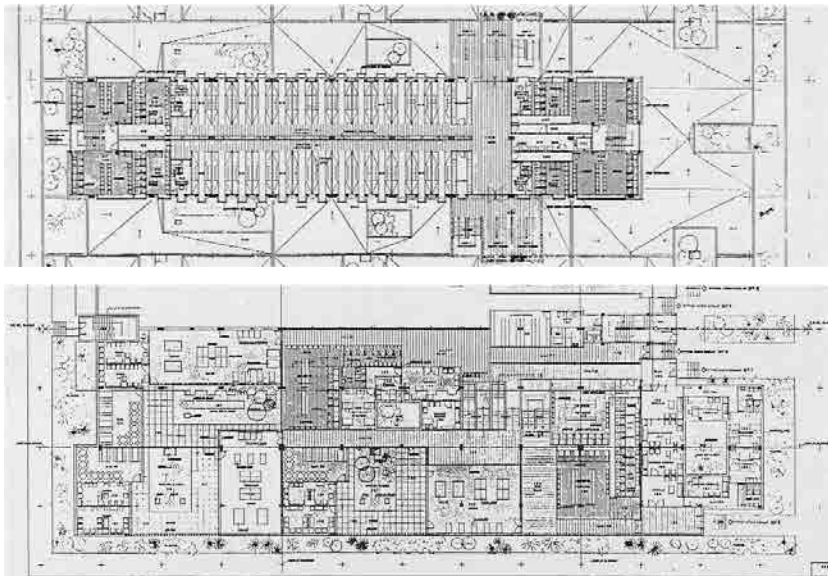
y Fig. 102 Residencias. Planta tipo de dormitorios (arriba) y planta baja de zonas comunes (abajo).
